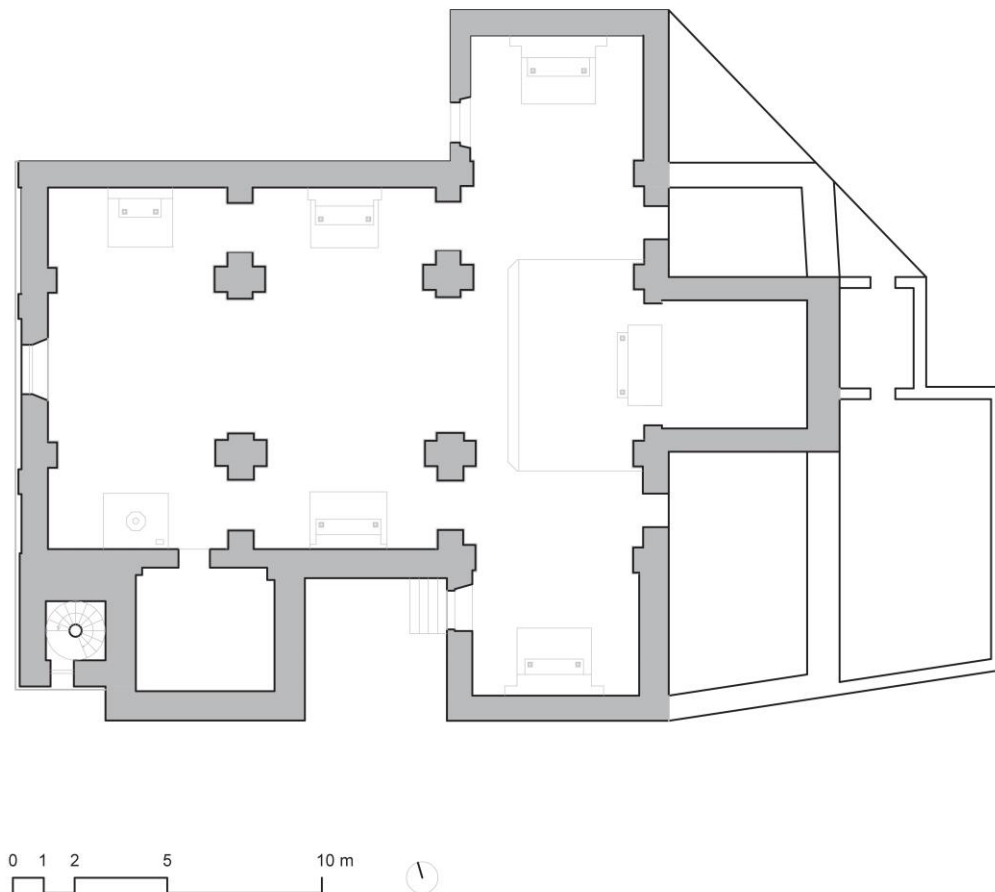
Planimetria schematica della Chiesa di Santa Maria delle Palme.
